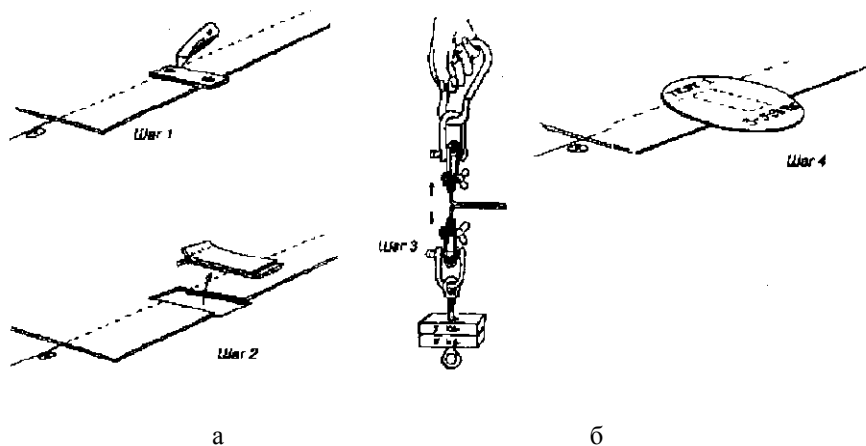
Проверка качества сварного шва (а) и заварка вырезанного участка шва (б). На заплатке отмечают № испытания, дату и ставят подпись кровельщика
